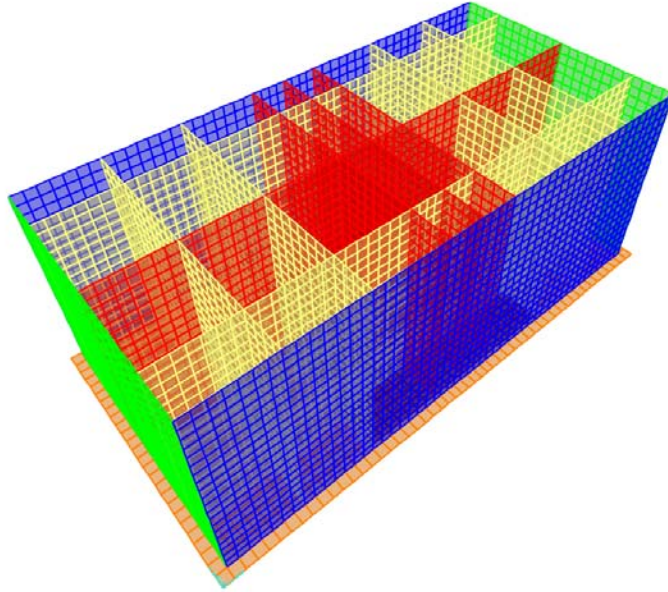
Vista 3D del cajón tipo modelizado mediante elementos finitos con SAP2000
